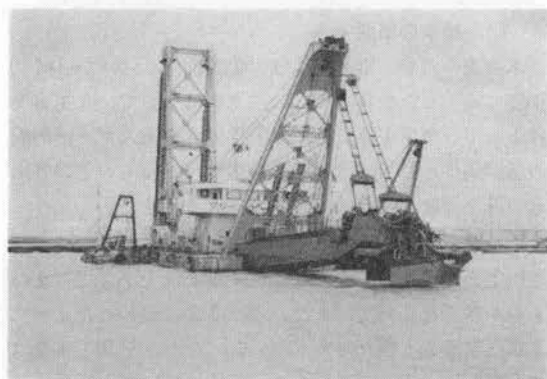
軟泥・ヘドロ専用浚渫船“クリーンナップ2号”
